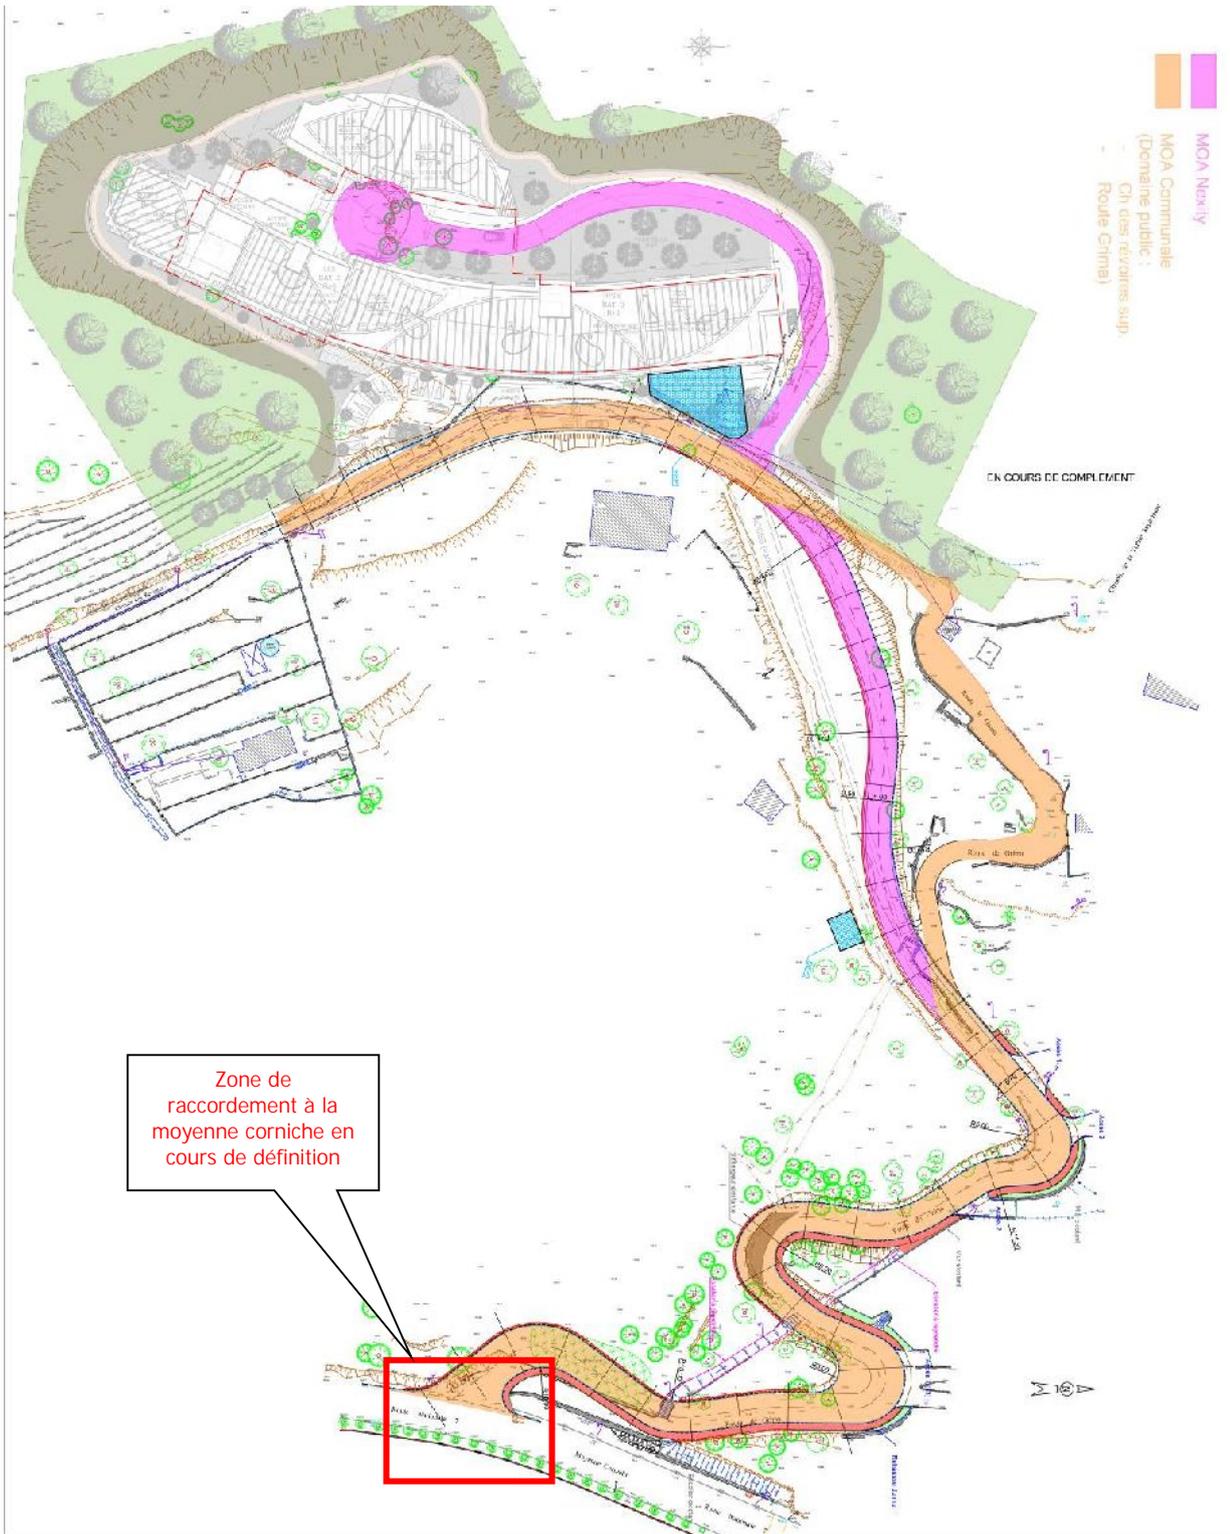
vue en plan de la voirie élargie et créée (Source : BETEC Ingénierie)
